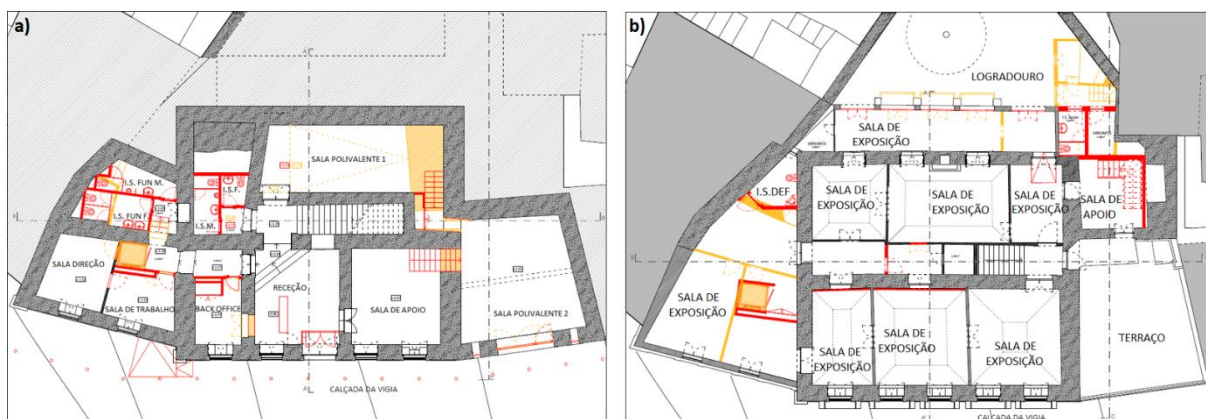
Plantas do edifício 1 em estudo: a) Planta do piso 0; b) Planta do piso 1
